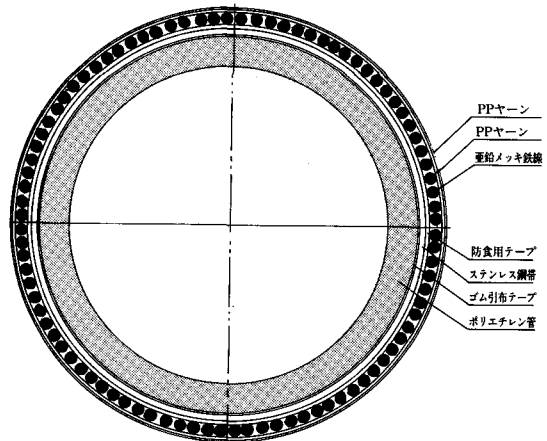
送水管(鉄線・装付ポリエチレン管)断面図
